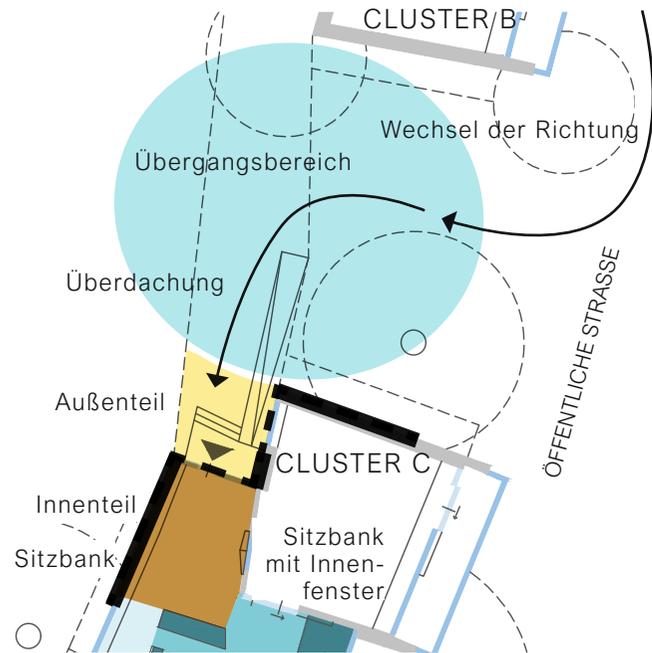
(oben) Eingangsraum Ausschnitt schematischer Grundriss (eigene Darstellung, Planquelle: Feyferlik/Fritzer)
